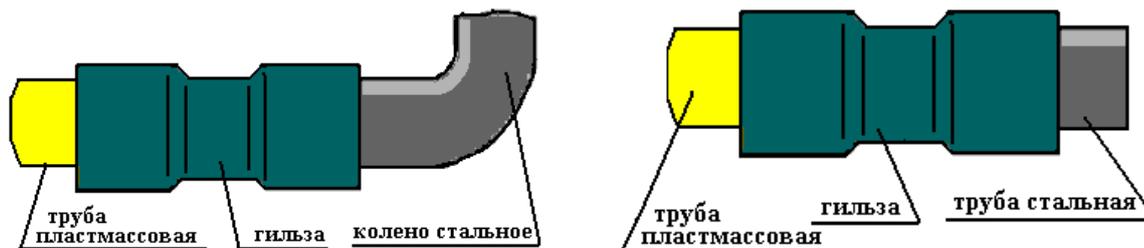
Соединение неметаллических труб при скрытой прокладке
